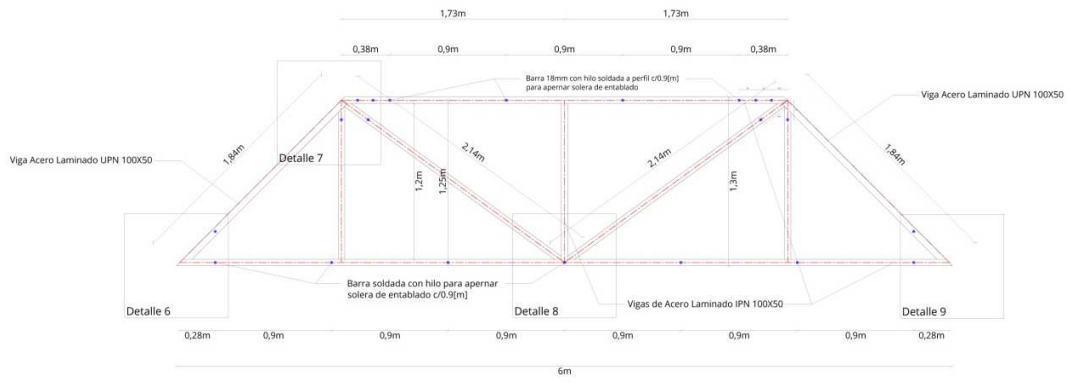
Detalle de cercha de acero 2. FUENTE: Elaboración propia.
